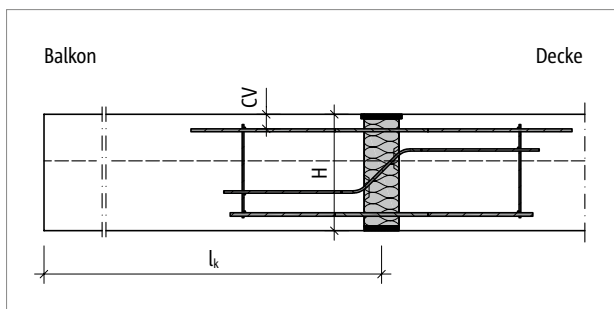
Schöck Isokorb® XT Typ BP: Statisches System
